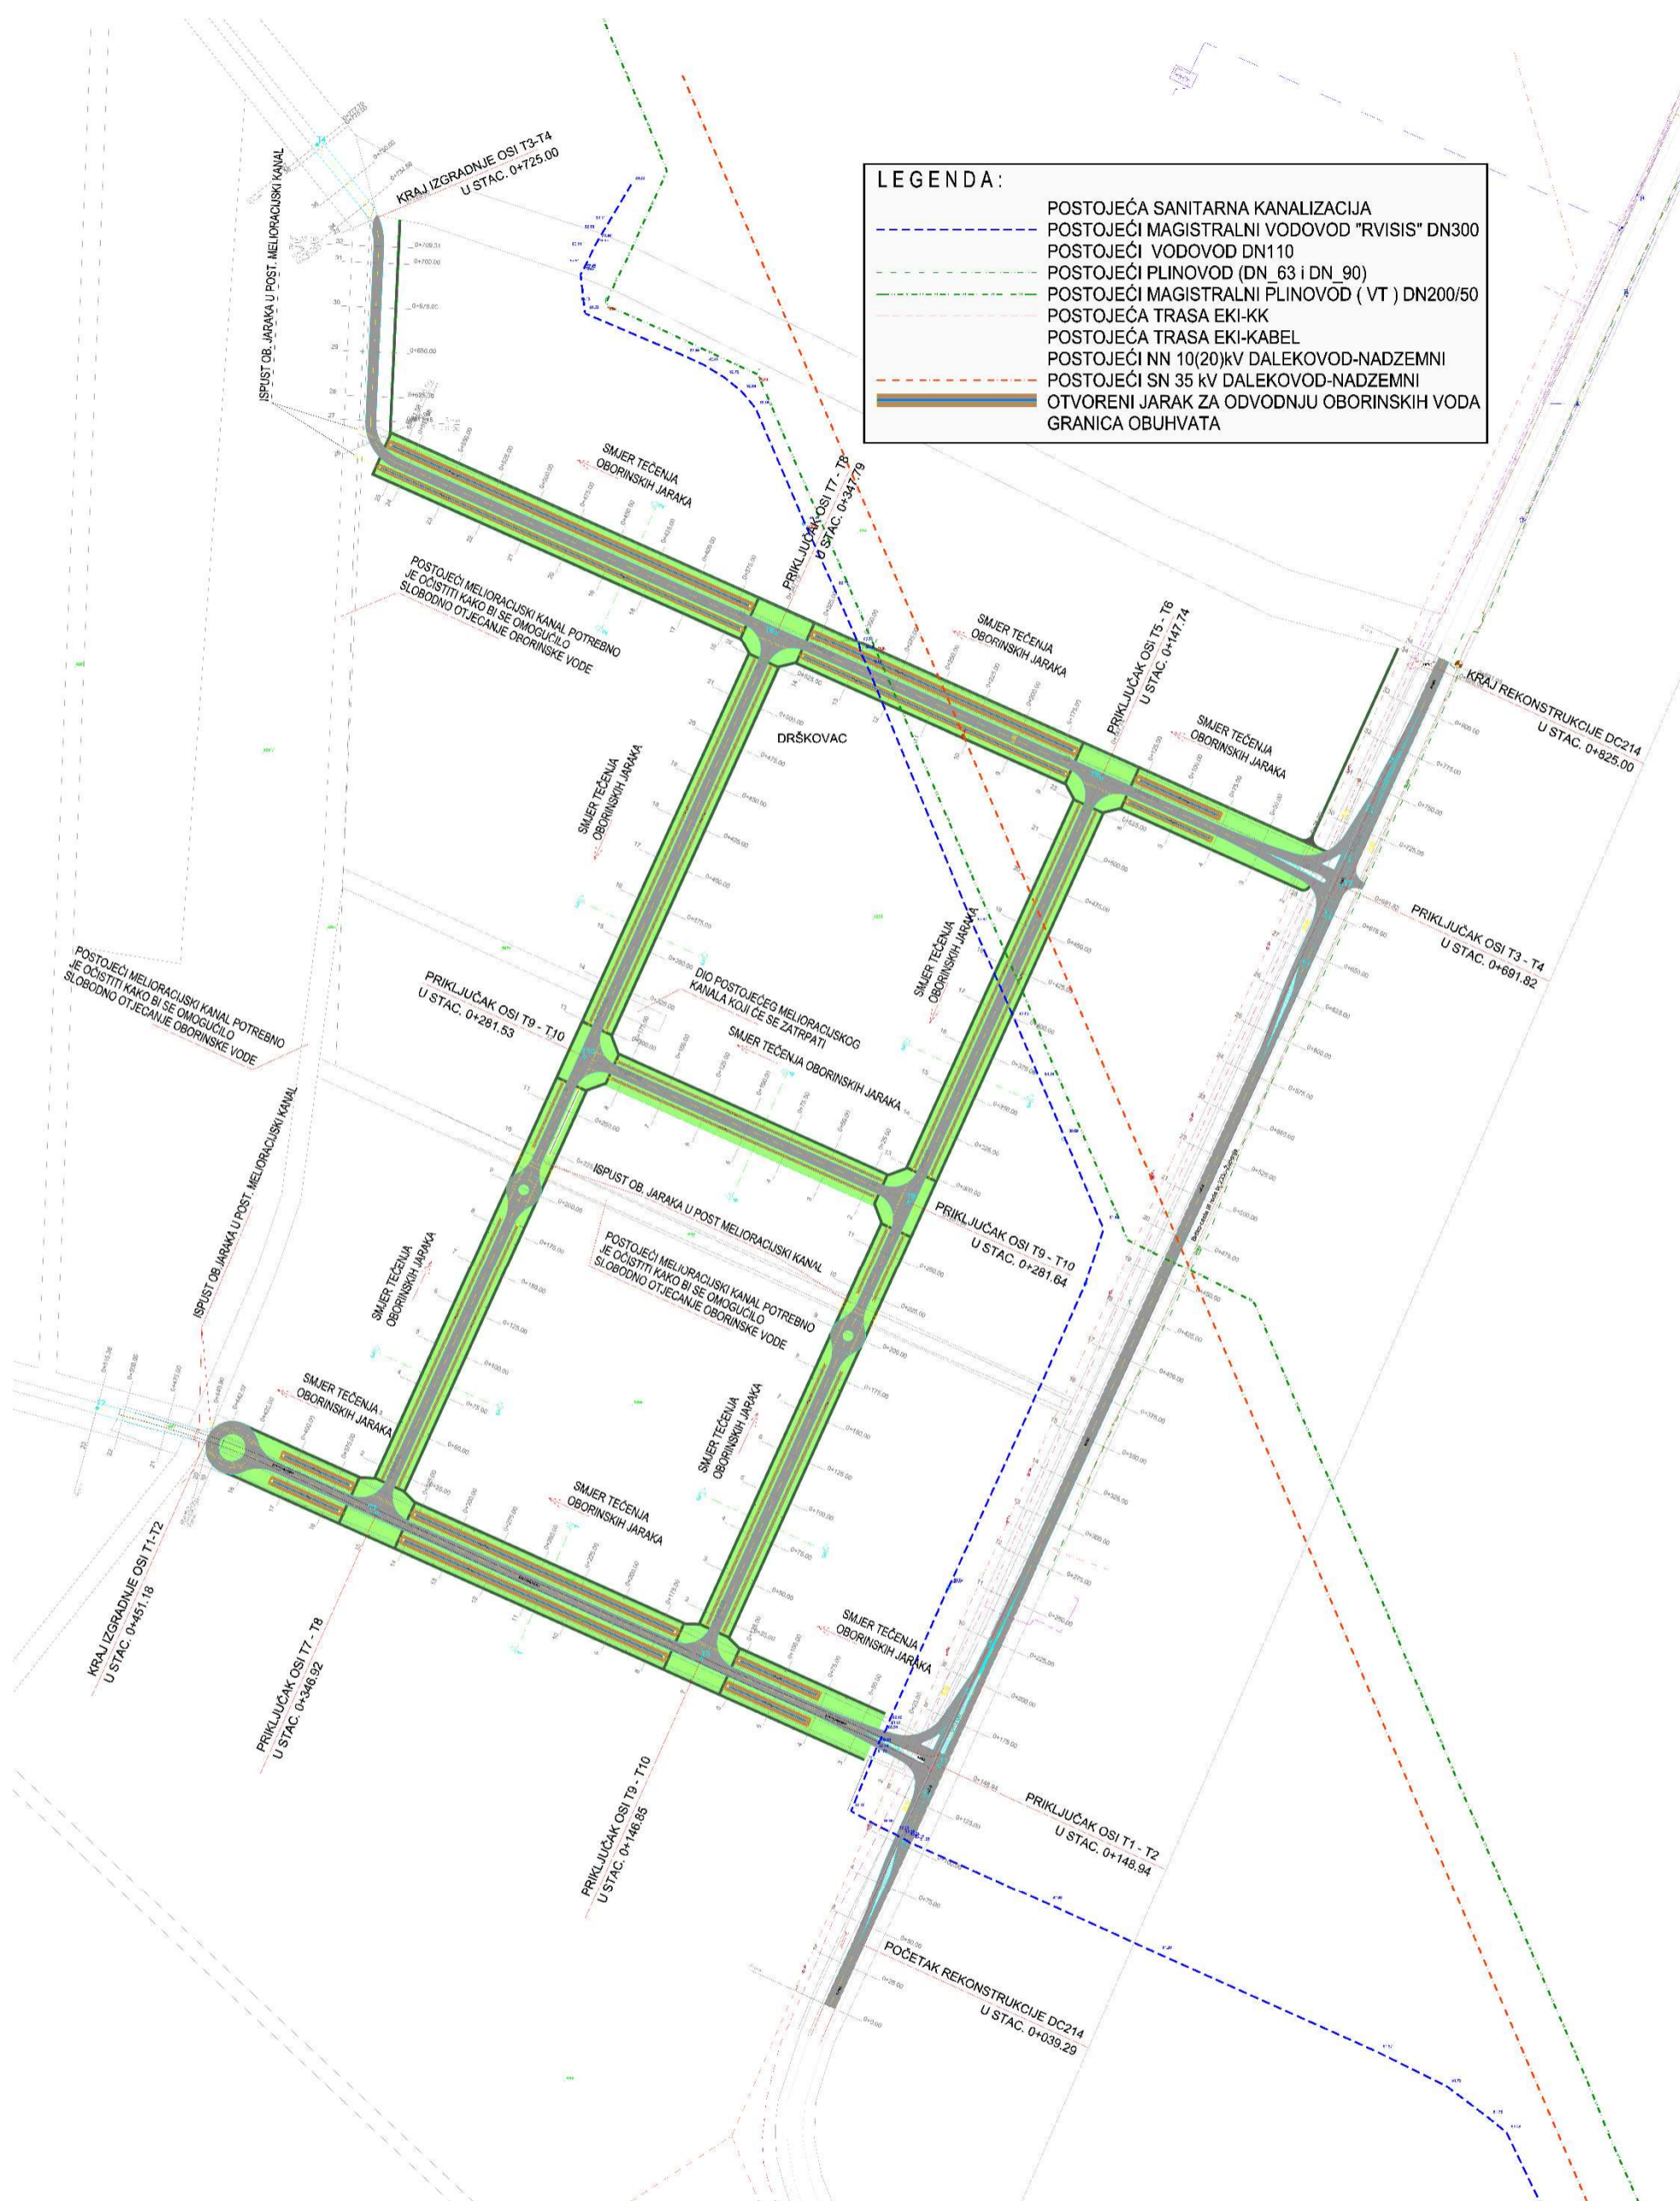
Situacija predmetne lokacije ucrtanim planiranim zahvatom (Izvor: Ivago -plan d.o.o.)
